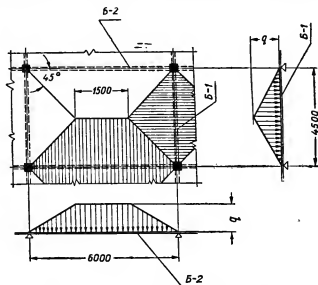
Схема распределения нагрузки на балки перекрытия с плитами, опираемыми по контуру.
